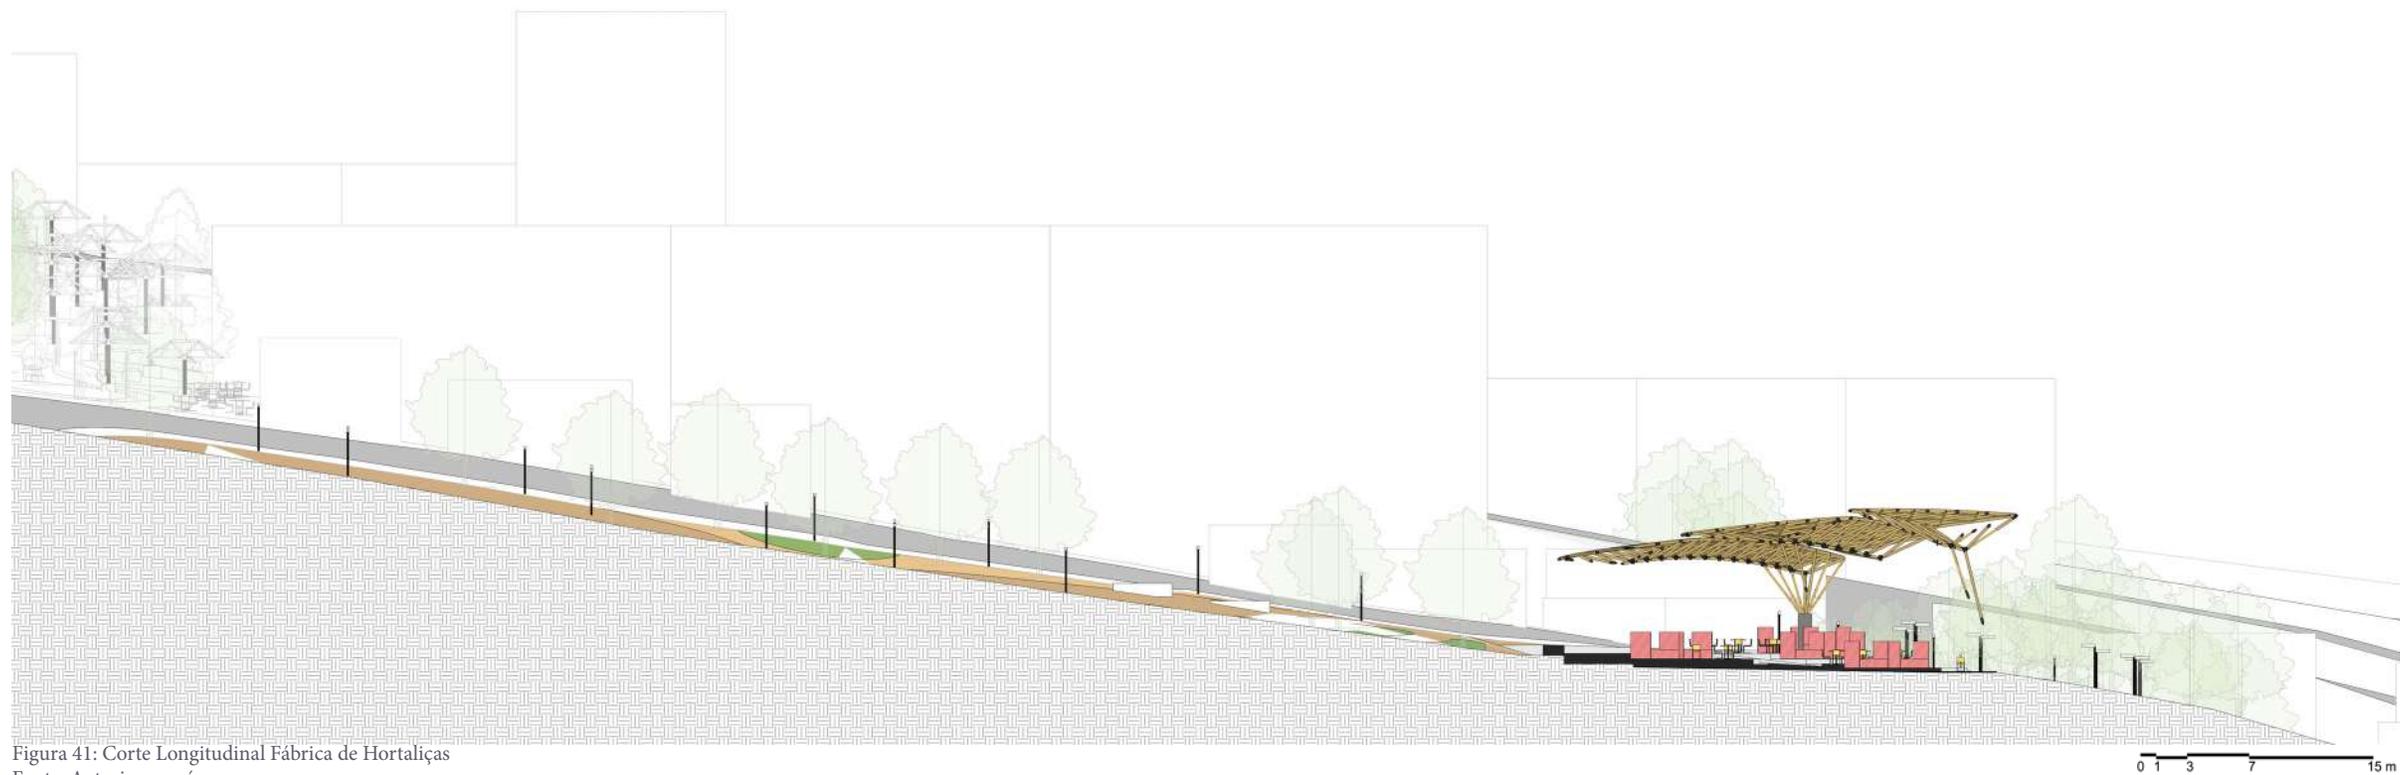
Corte Longitudinal Fábrica de Hortaliças
